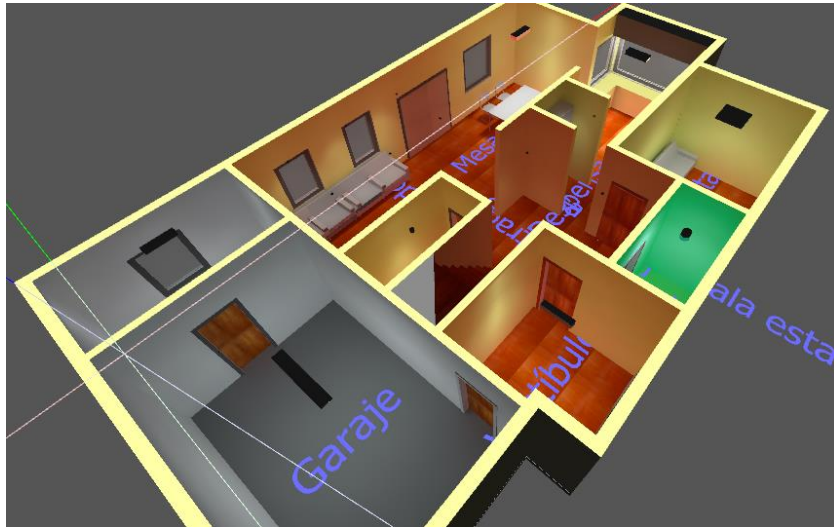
Vista general de la planta baja de la vivienda con el programa Dialux.
